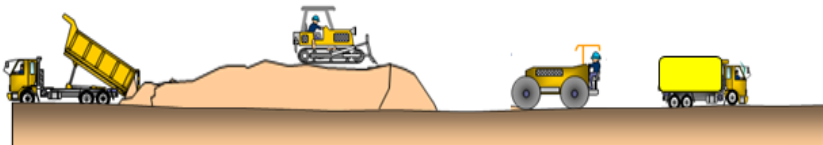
Layout Rencana Pelaksanaan Pekerjaan Tanah STA 37+297 s/d STA 42+800
